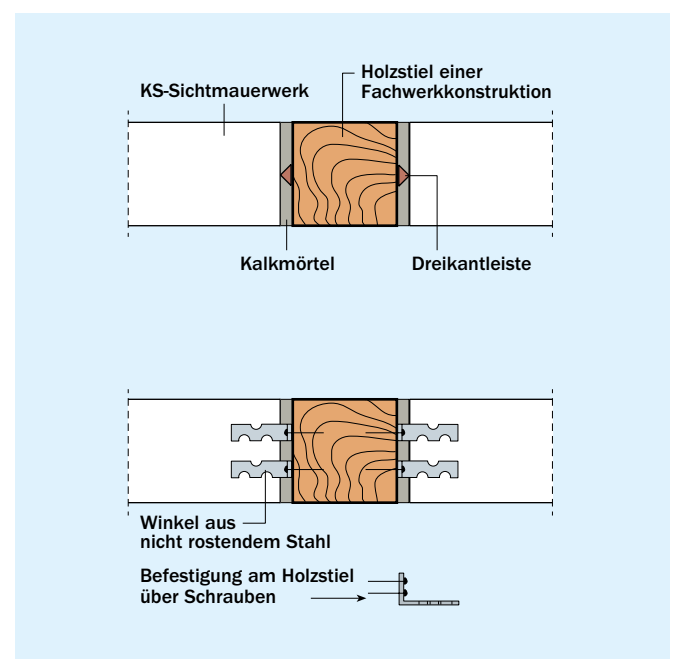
Wandanschluss von KS-Sichtmauerwerk an eine Holzfachwerkkonstruktion
